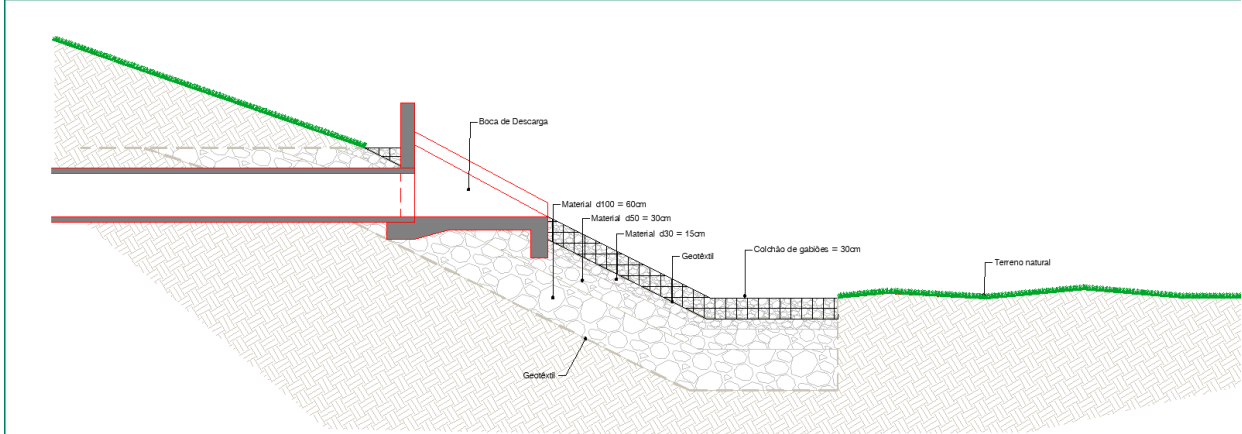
Pormenorização da Descarga de água pluviais nas bacias de infiltração
